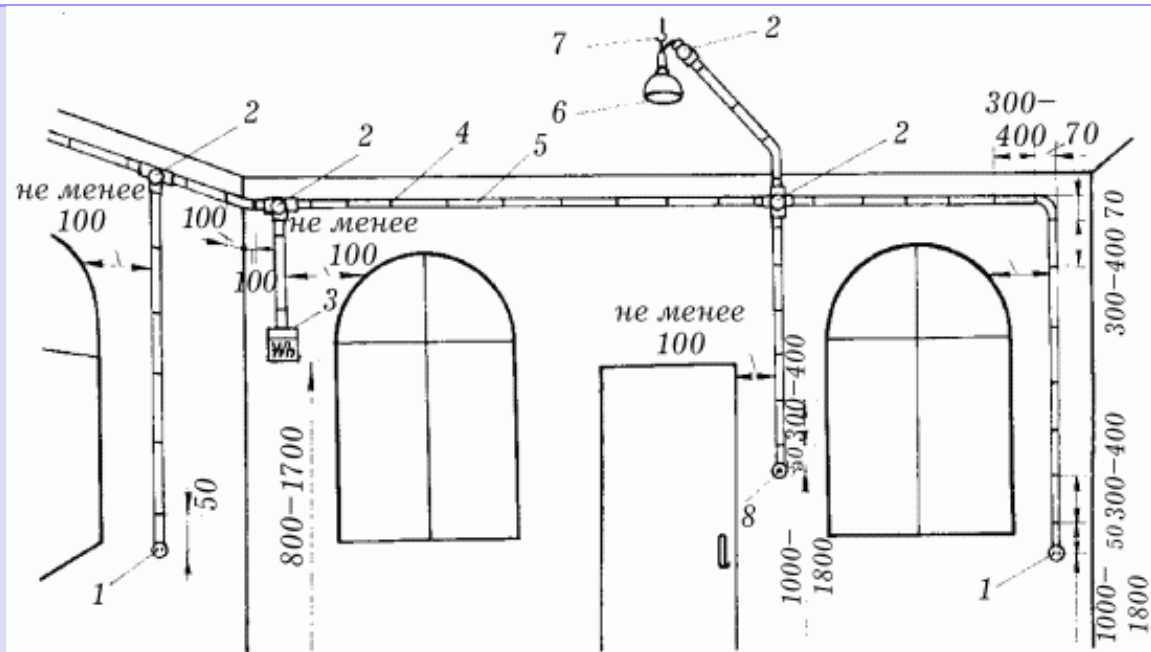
Открытая прокладка проводов и кабелей (общий вид) внутри помещения: 1 – розетка штепсельная; 2 – коробка разветвительная; 3 – электросчетчик; 4 – места крепления проводов к основанию; 5 – провод электропроводки; 6 – светильник; 7 – крюк для крепления светильника; 8 – выключатель.
